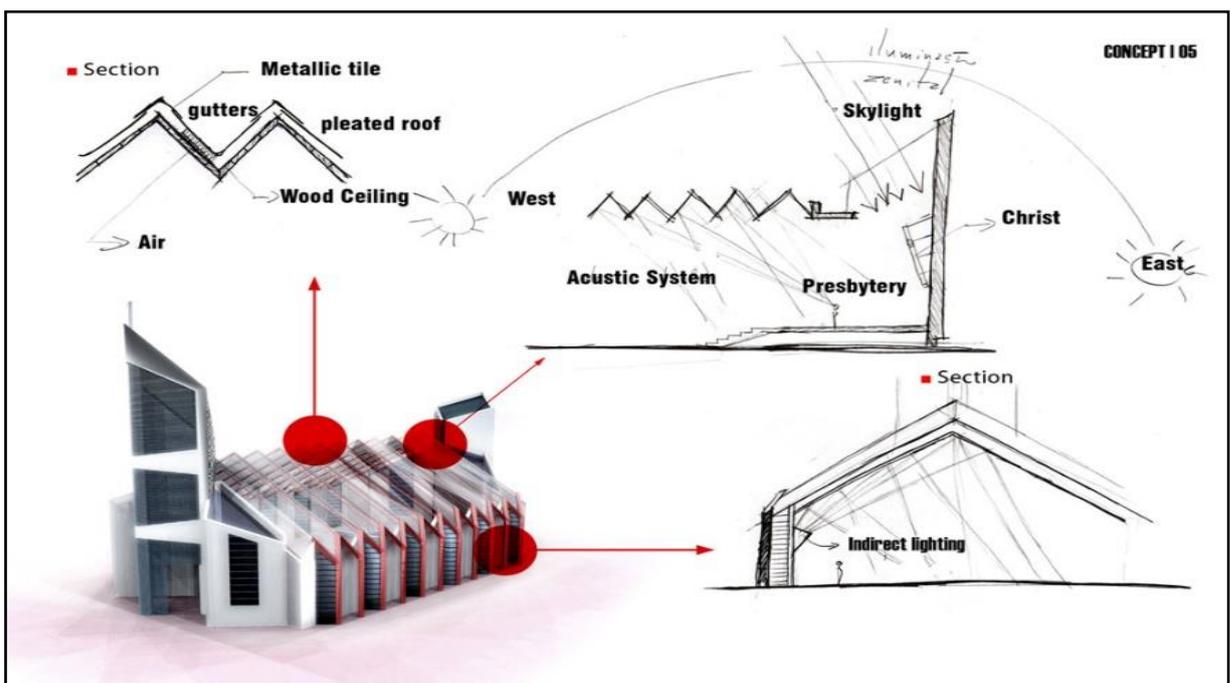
Croquis da cobertura da Igreja de Santa Teresa D'Ávila
